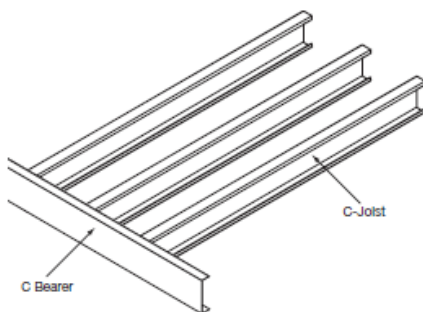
Vigas utilizadas por el sistema Stramit (Tomado de: Stramit Buildings Products)
